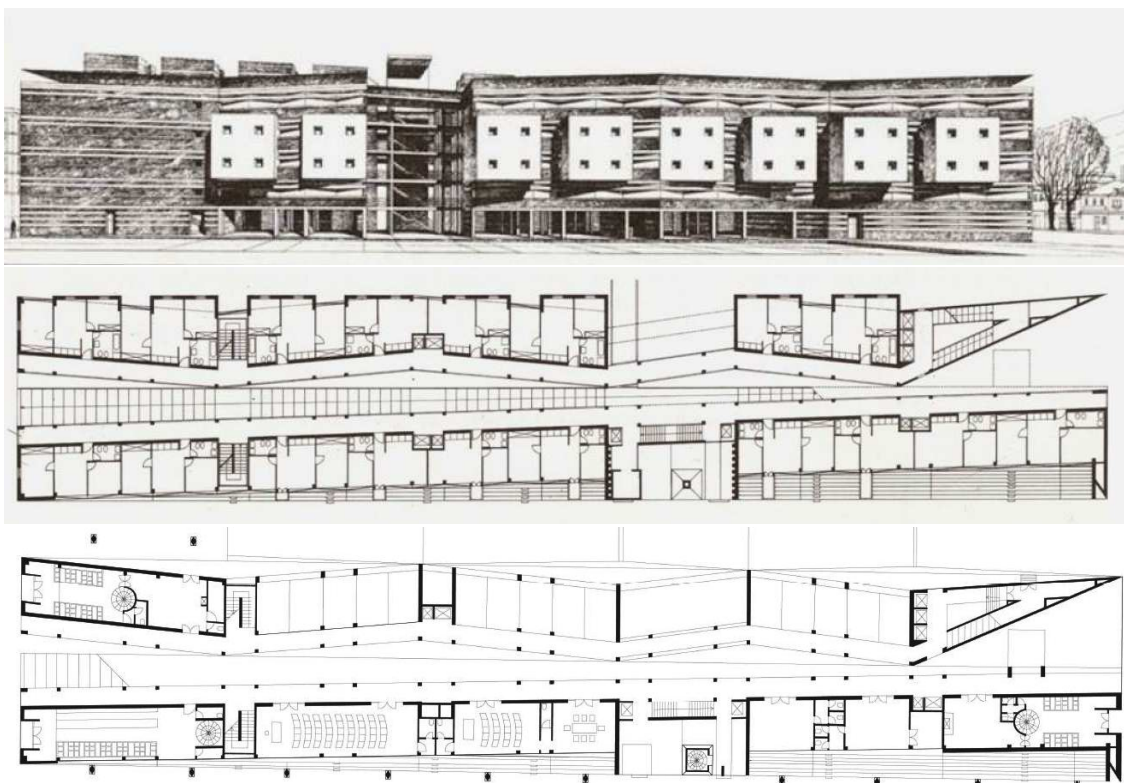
Anselmi A., *Residenze Temporanee al Testaccio: prospetto, piano tipo e terra*, Roma, 1984.
